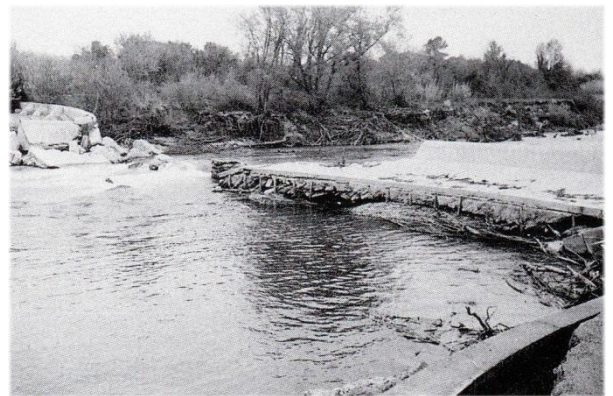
Le barrage détruit après la crue en février 1964 (photo Edmond Lassalvy).
